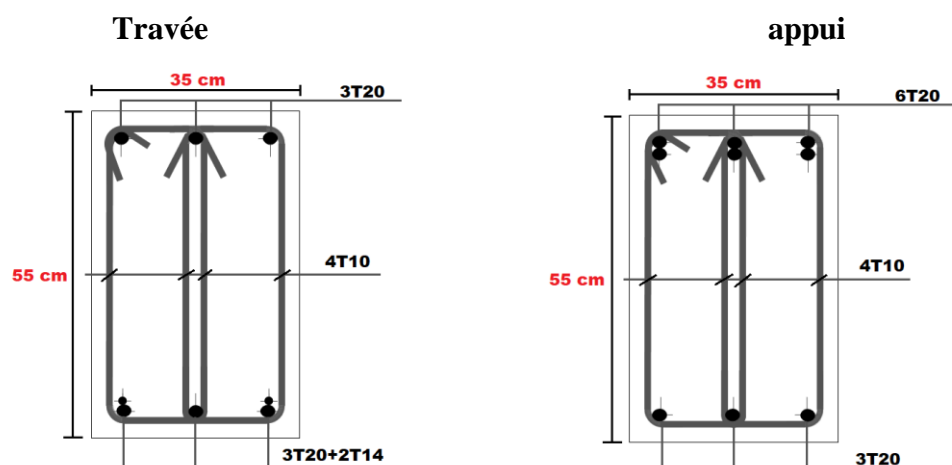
ferrailage des poutres principales 35×55 (terrace).
